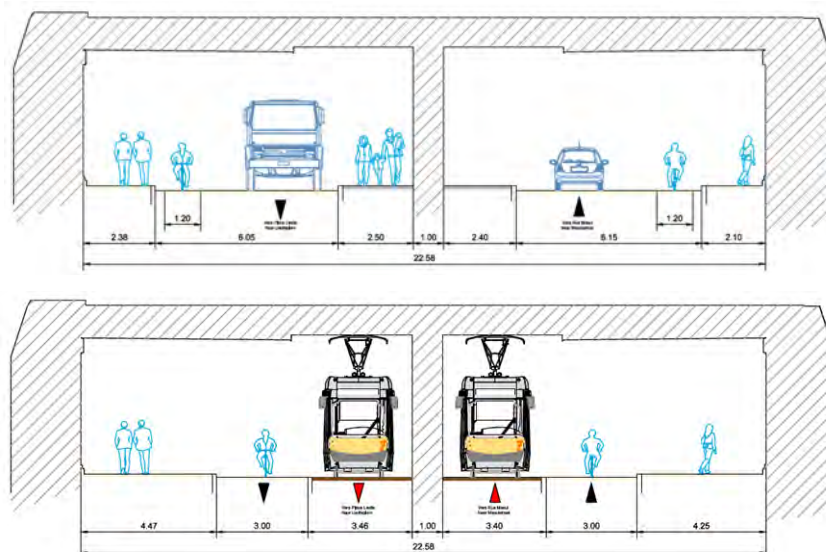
Coupe du tunnel de l'avenue de la Reine : situation existante (en haut) et situation projetée (en bas) (ARIES, 2020)
